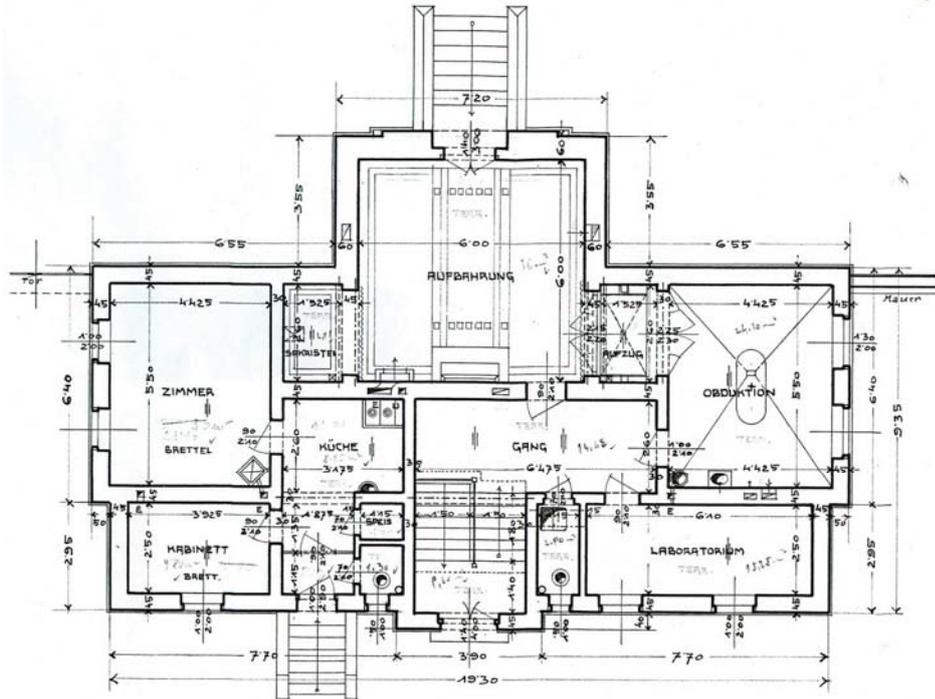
ERDGESCHOSSGRUNDRISS AUFBAHRUNGSKAPELLE
